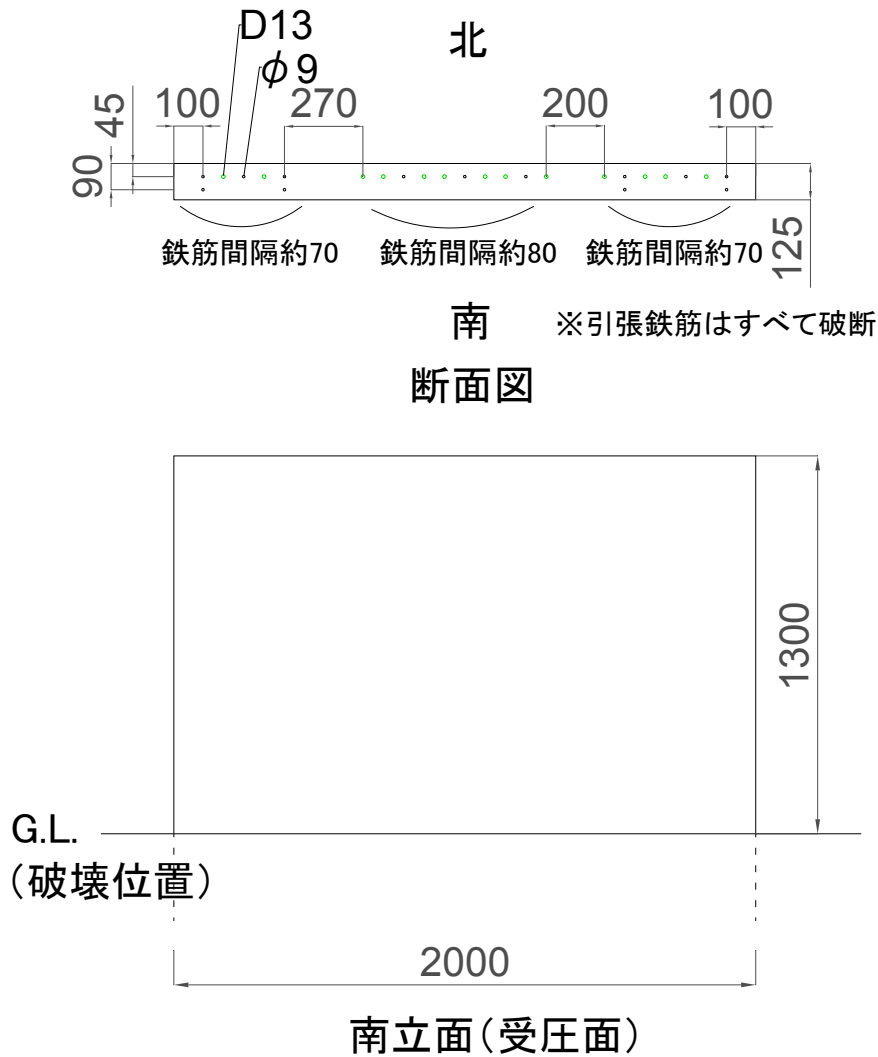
擁壁の立面図および断面図 (単位: mm)
